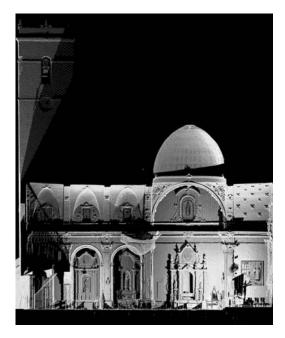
Sección Longitudinal proporcionada por el barrido del Escáner Láser 3D (Navarro 2010)
